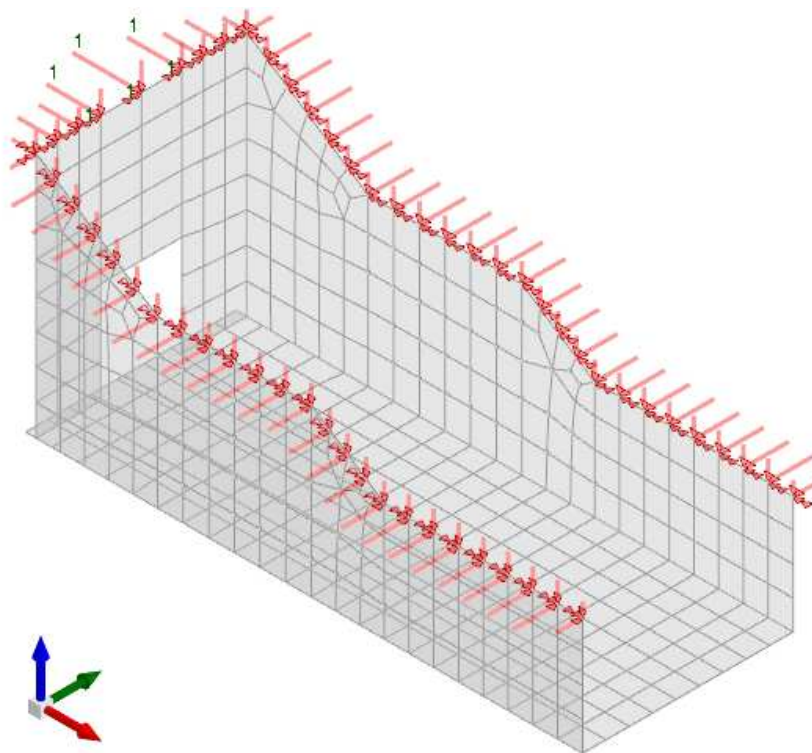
Condizione permanenti NON strutturali [daN] (parapetto)
